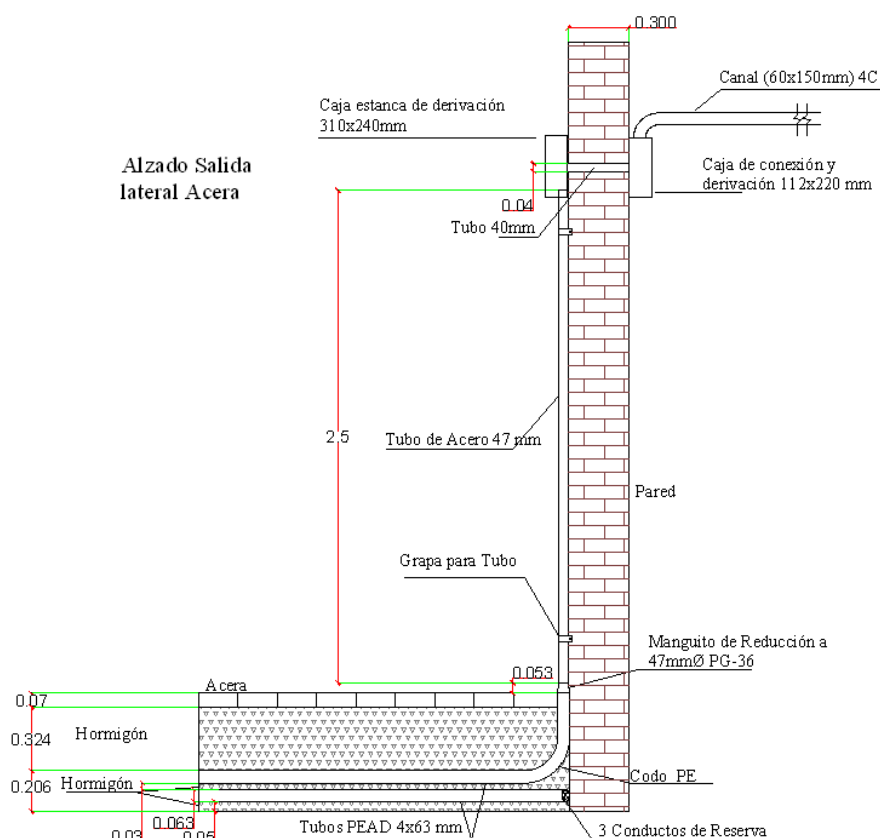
Alzado salida lateral a fachada de la Red de Acceso
